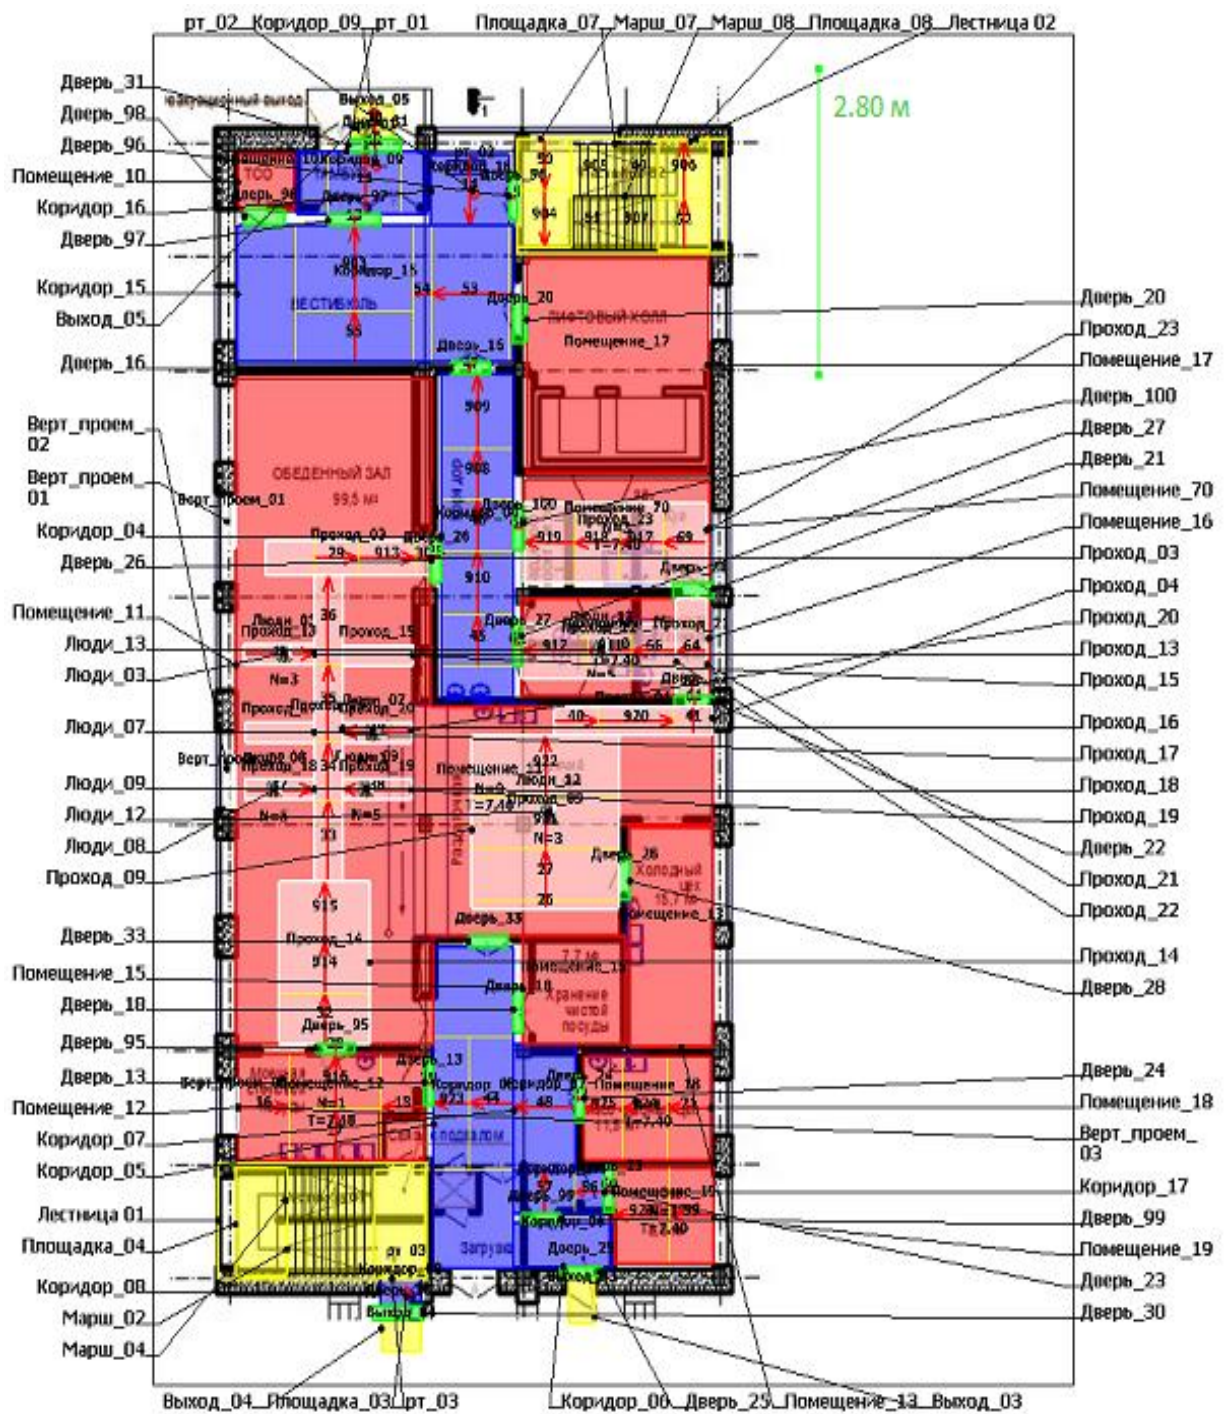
Расчетная схема эвакуации для первого этажа
